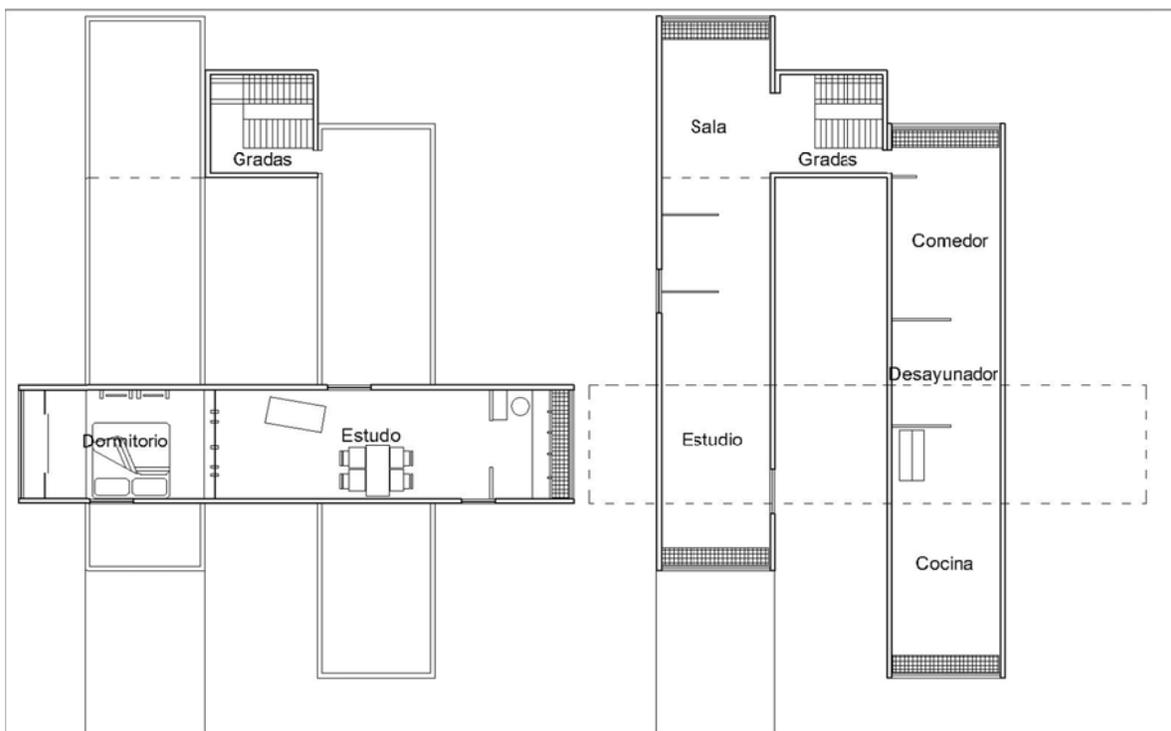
planta arquitectónica que destaca la distribución de los ambientes dentro de cada uno de los contenedores
